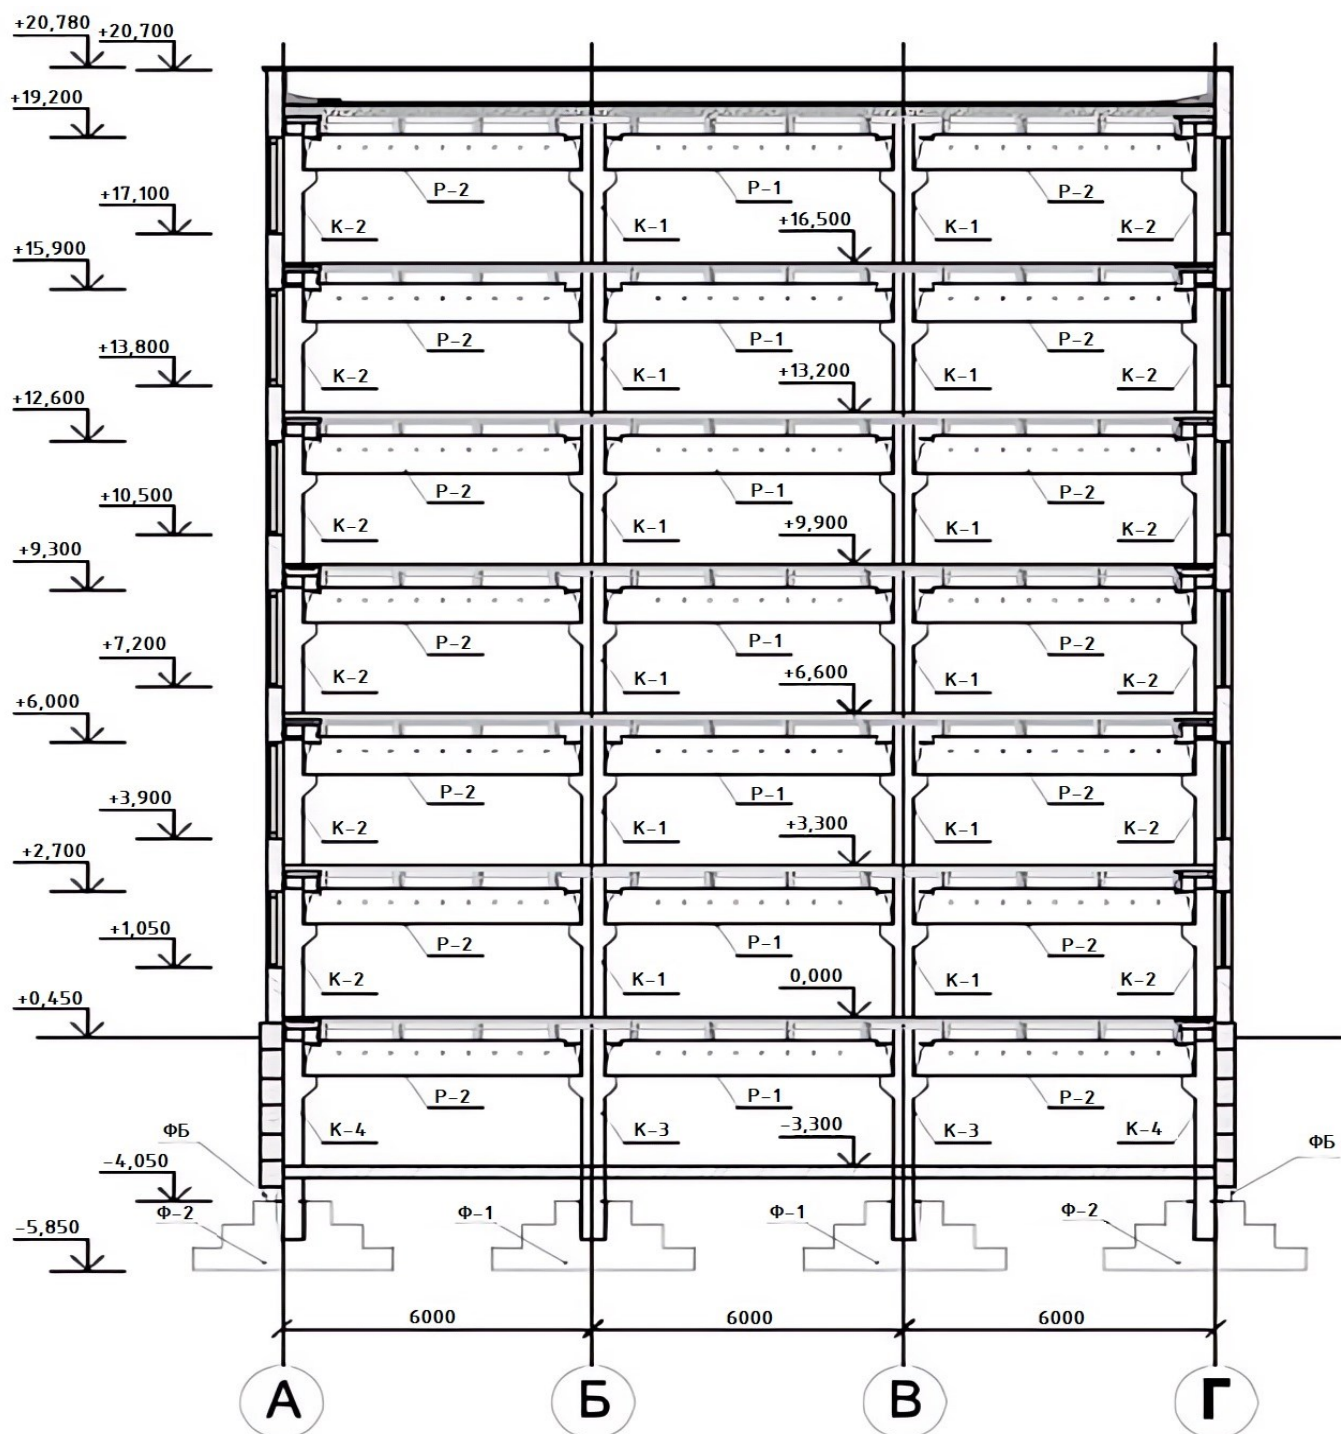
Каркасная конструктивная система многоэтажного здания с применением сборных железобетонных колонн поэтажной разбивки
